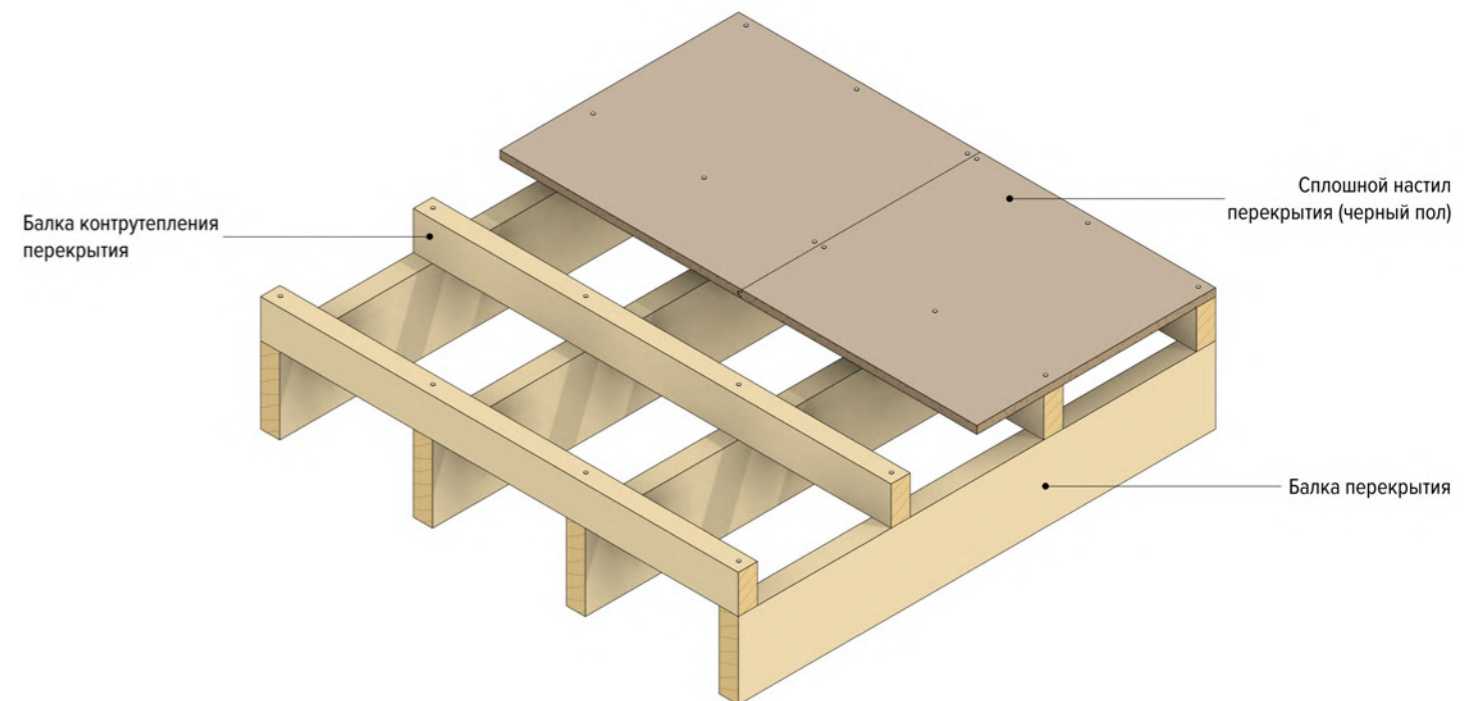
Основные конструктивные слои каркаса цокольного перекрытия
